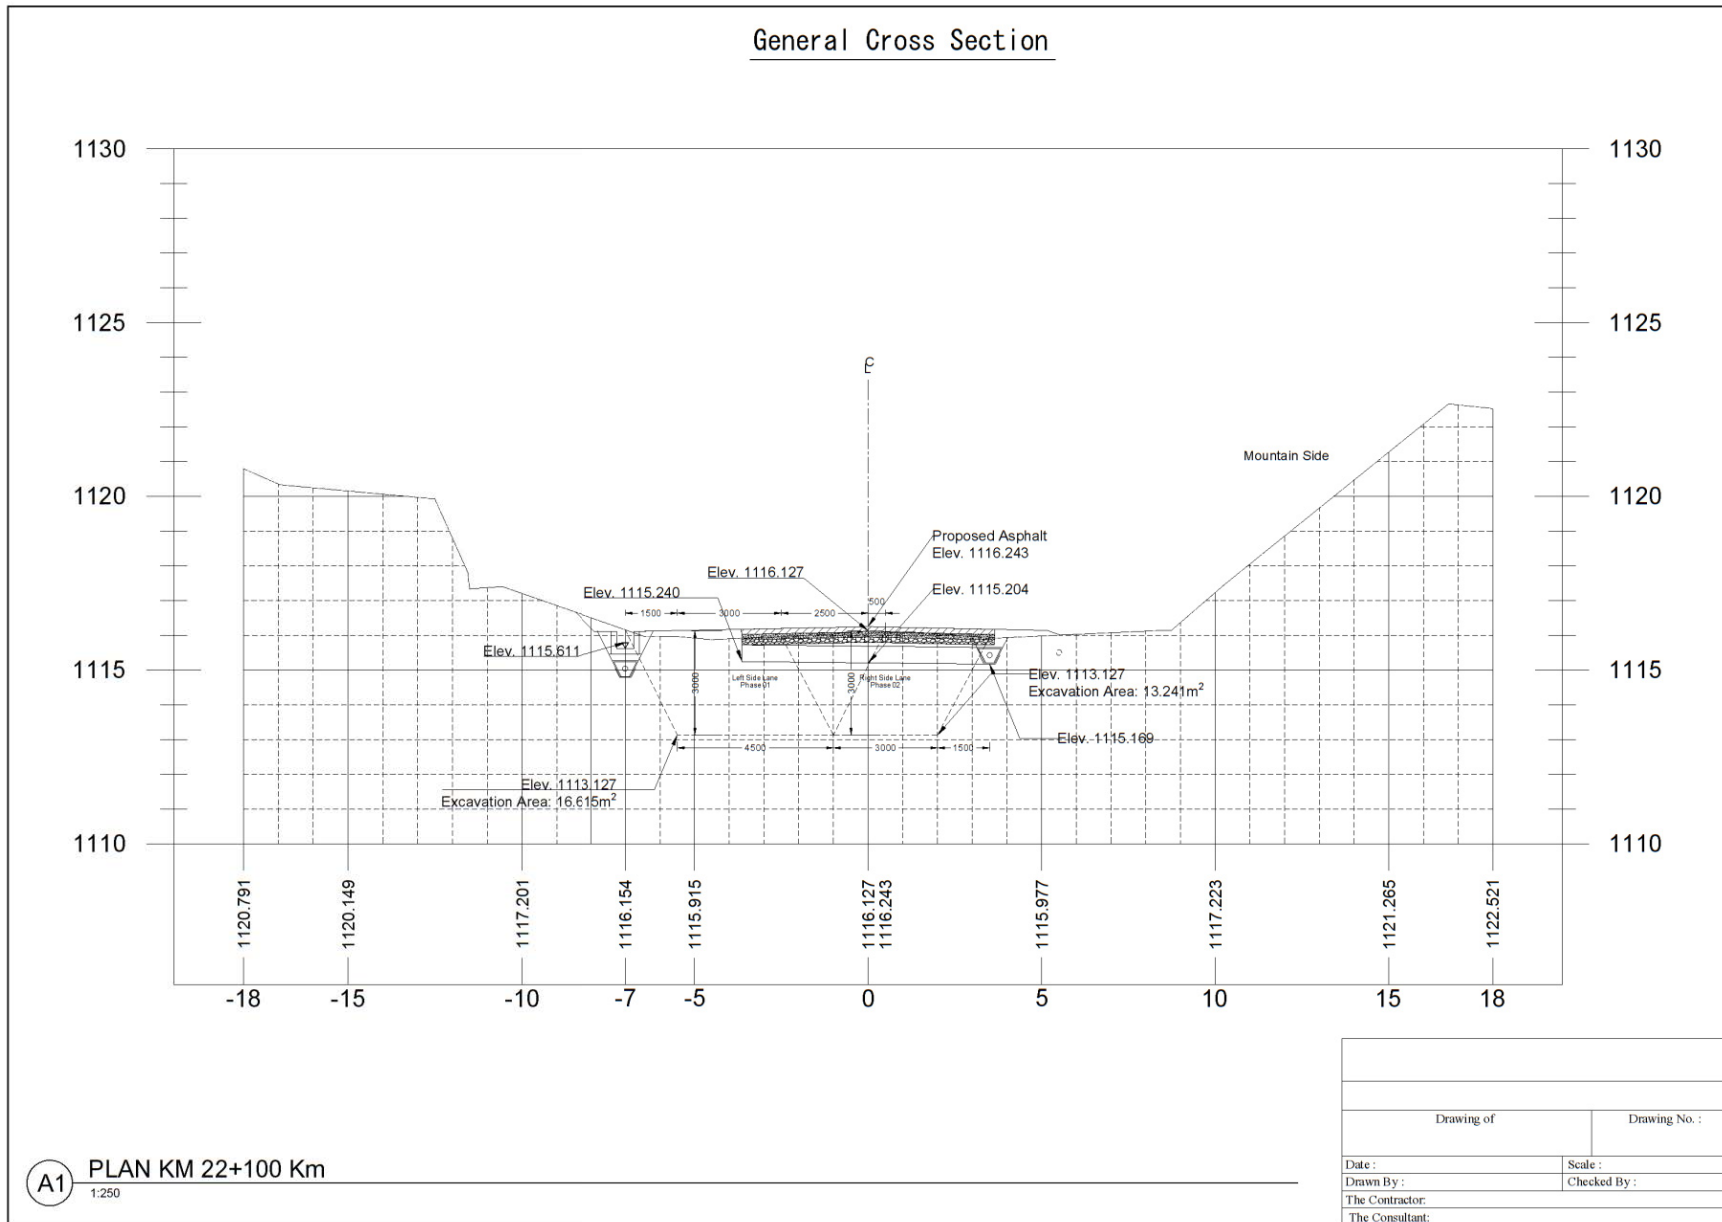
Sta. 22+000a 標準断面図 (Non-Scale)
